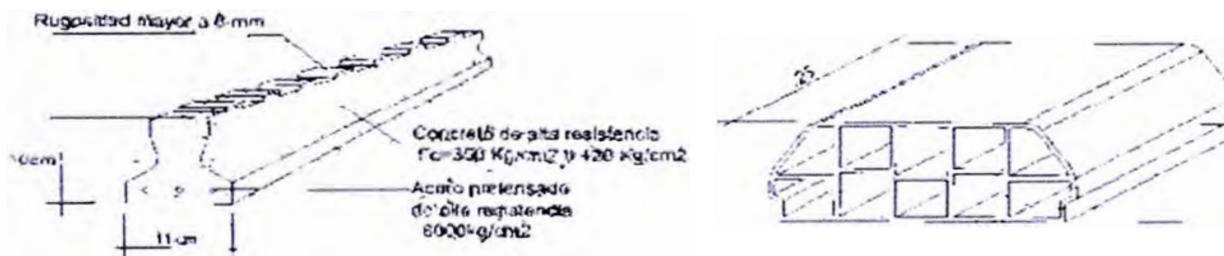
Detalle de vigueta pretensada Firth y bovedilla de arcilla
